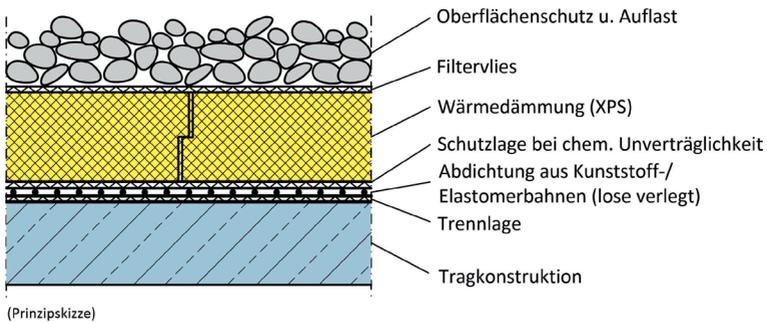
Umkehrdach auf Stahlbetondecke (Quelle: Schmidt)
